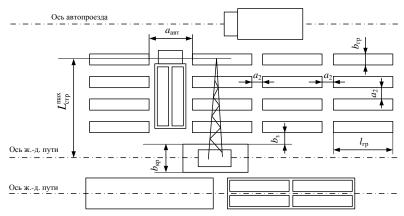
Расчетная схема для определения параметров открытого склада для тяжеловесных грузов с использованием стрелового железнодорожного крана по методу элементарных площадок
